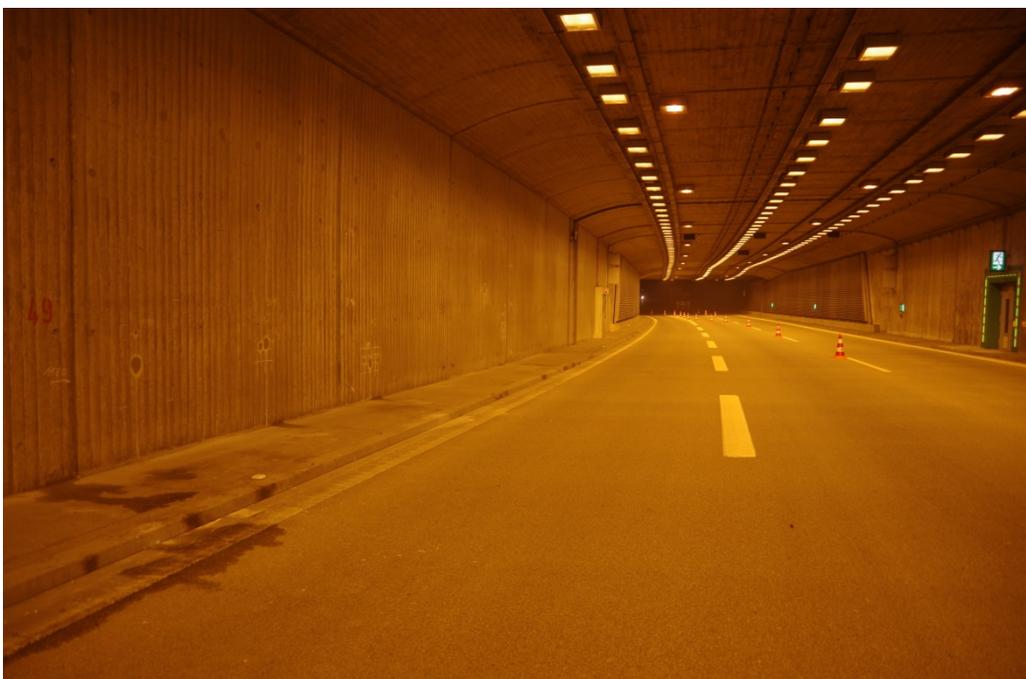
Tunnel Prüfening, Einfahrtbereich der Weströhre mit Lärmschutzelementen (im Bildhintergrund)
